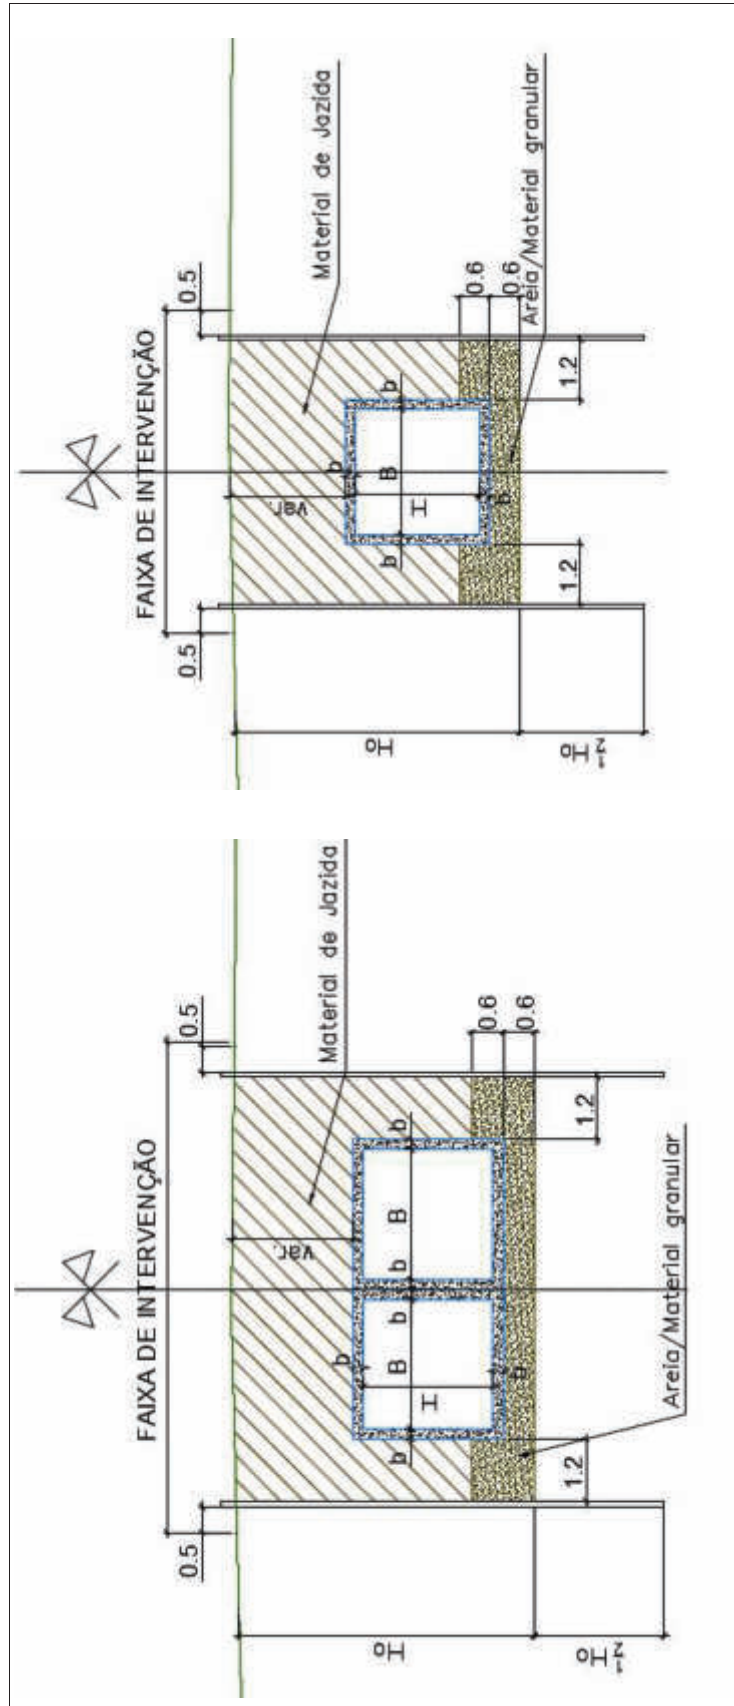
Seções típicas dos drenos em galeria celular de concreto
